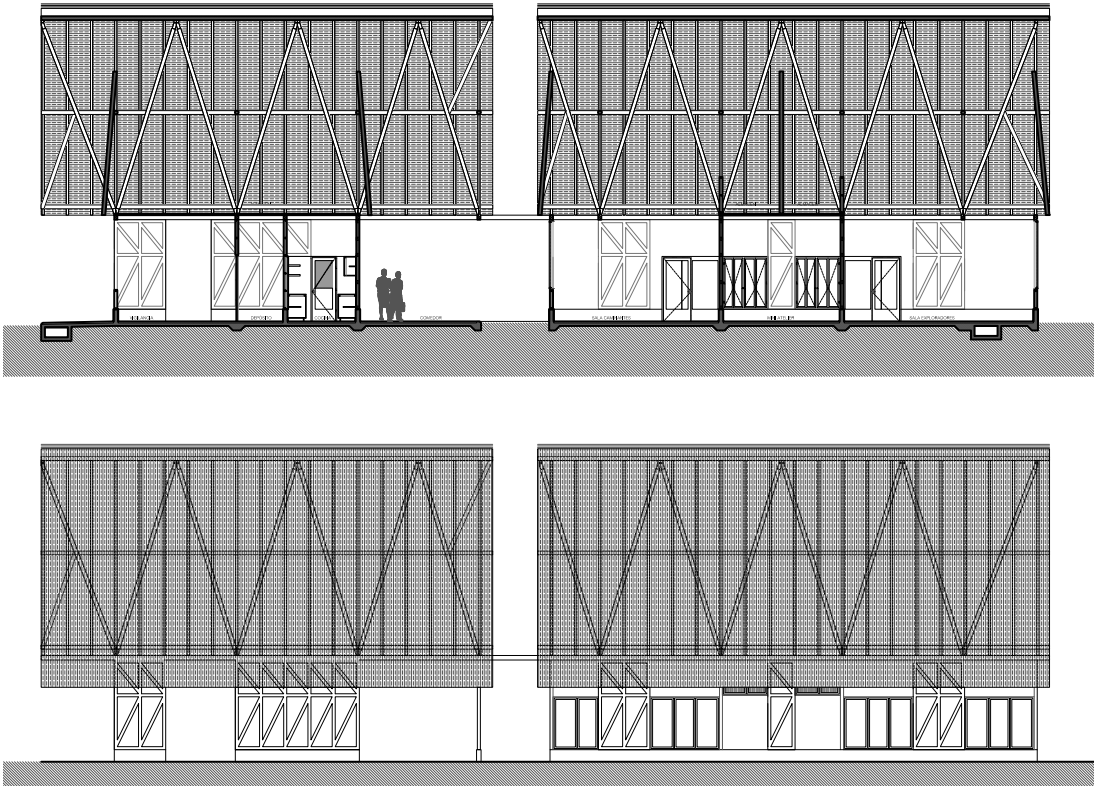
Sección longitudinal y elevación lateral. Elaboración: Equipo proyectista, 2014.
